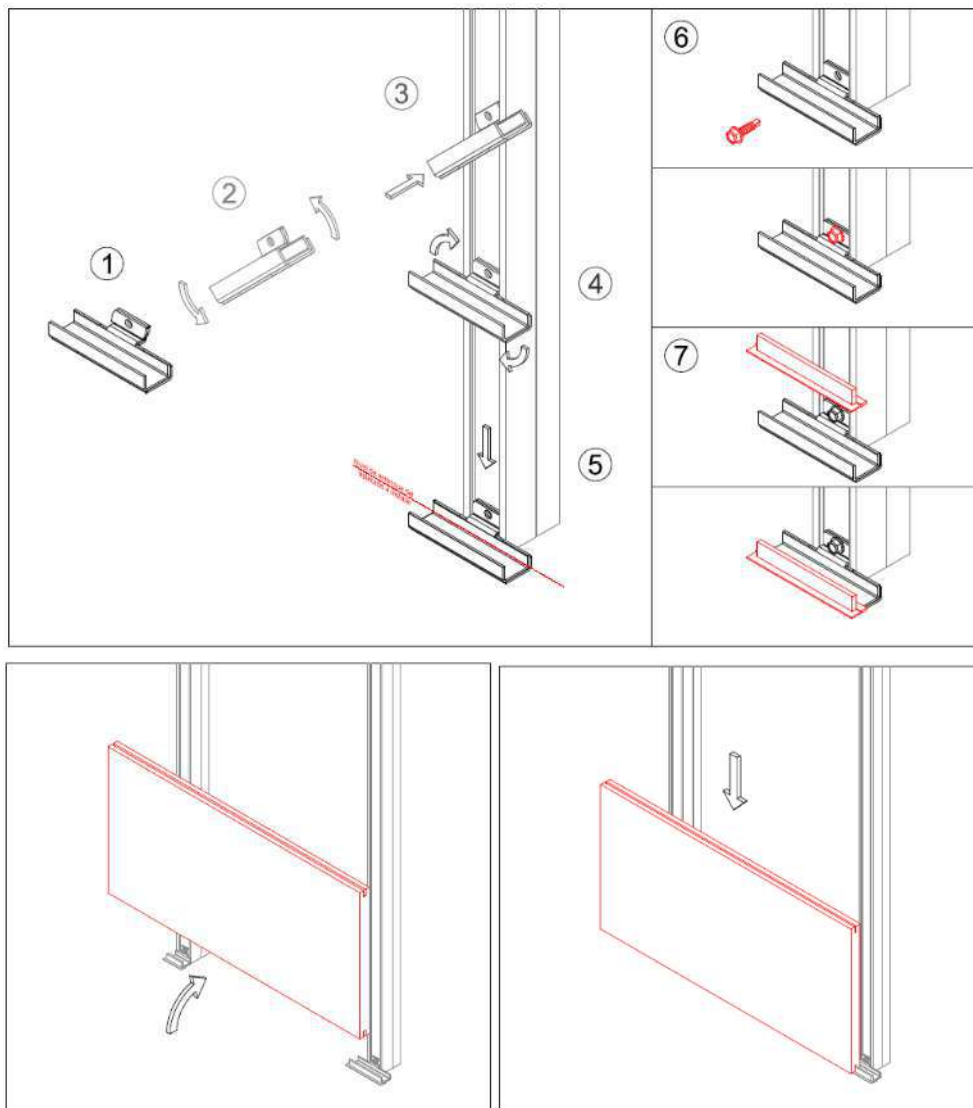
Esquema de puesta en obra. Sistema Masa. Cedida
